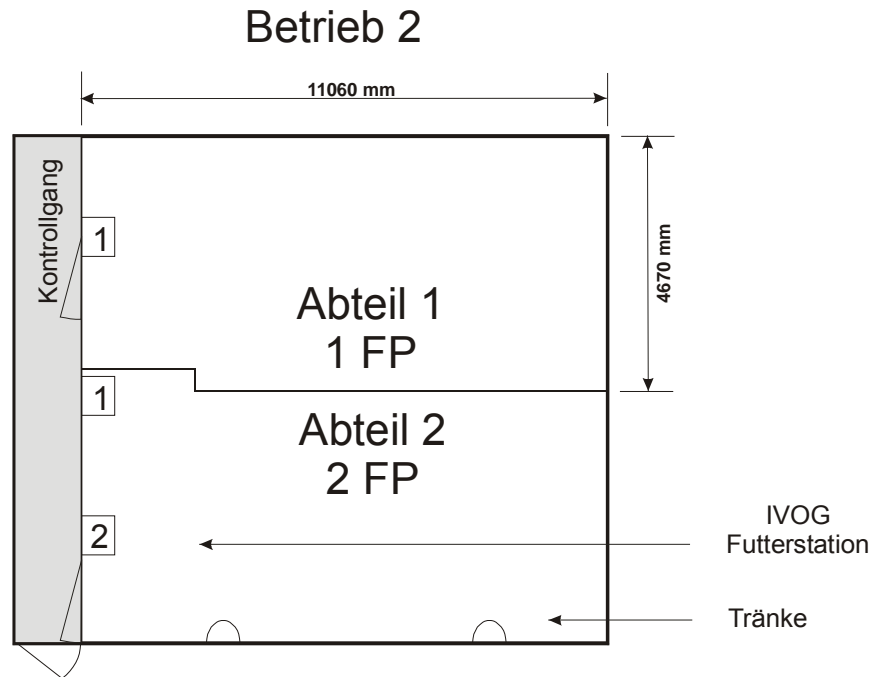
Grundriss der Versuchsbuchten in Betrieb 2
